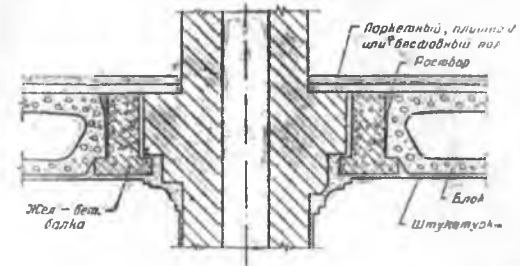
Перекрытия с несущими пустотелыми шлакобетонными олоками
